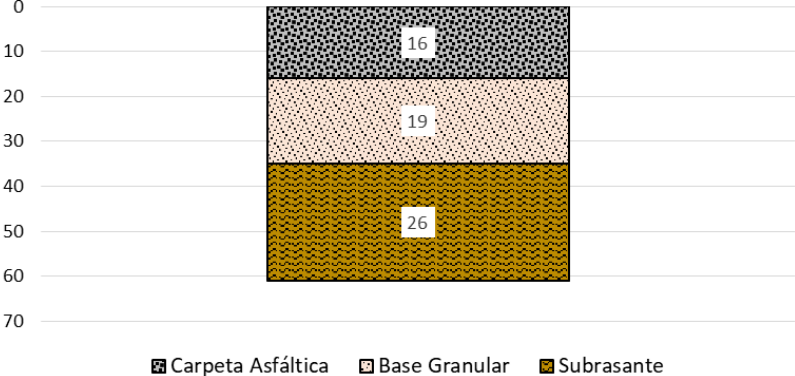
Estructura de Pavimento Flexible Propuesta
